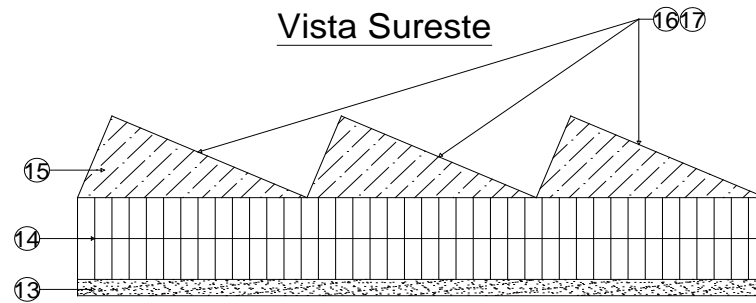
Detalle de N° de paredes y techo según orientación.
